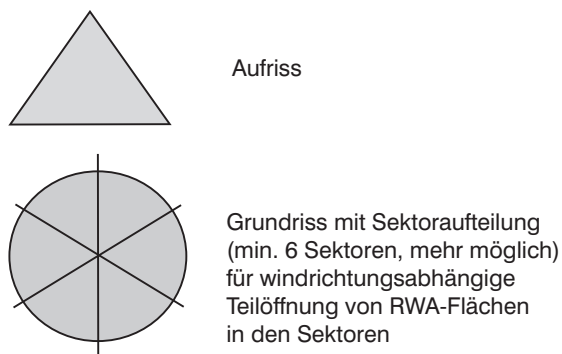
Sektoreinteilung runder Grundriss, z.B. Oberlicht zur Verdeutlichung
